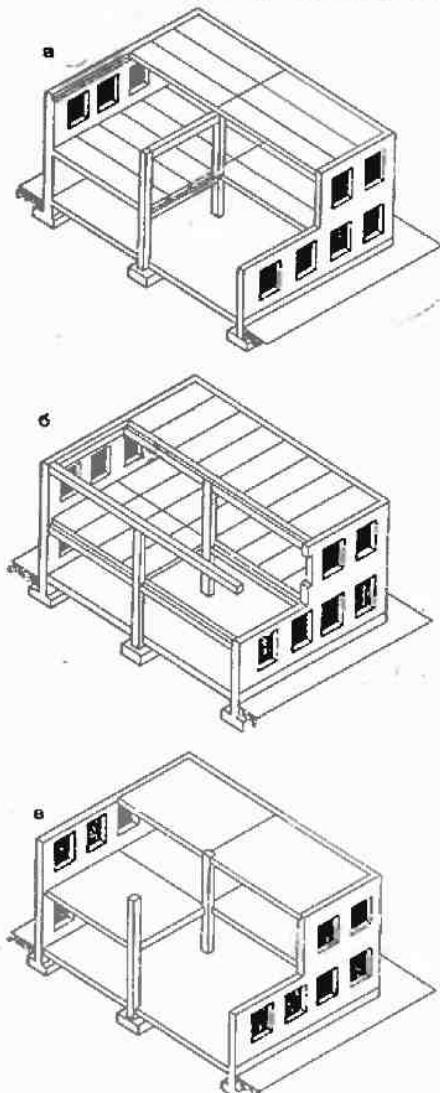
Конструктивные схемы зданий с неполным каркасом
